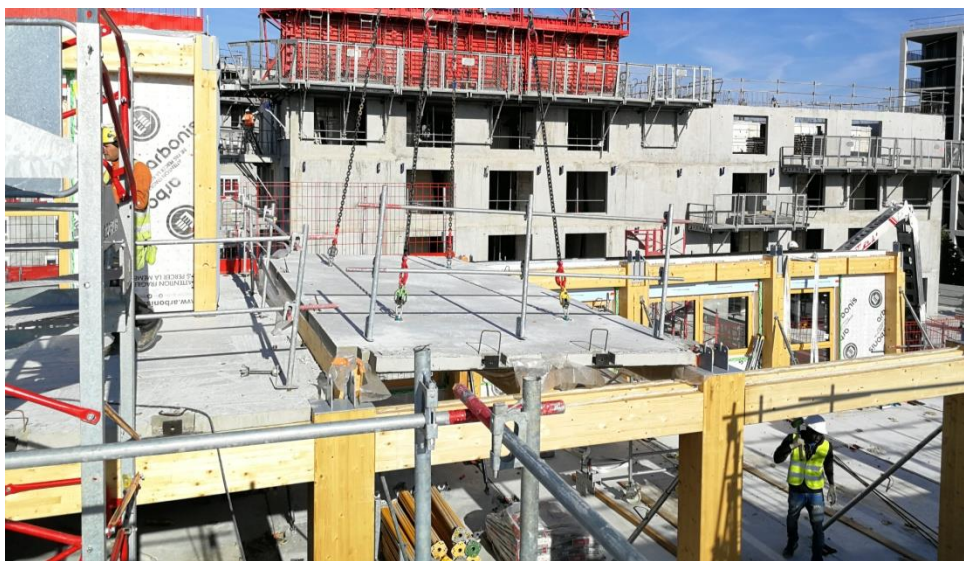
Pose des planchers Arbodal® - Aout 2019 - R+3 - Photo Chantier ©Art'ur Architectes
